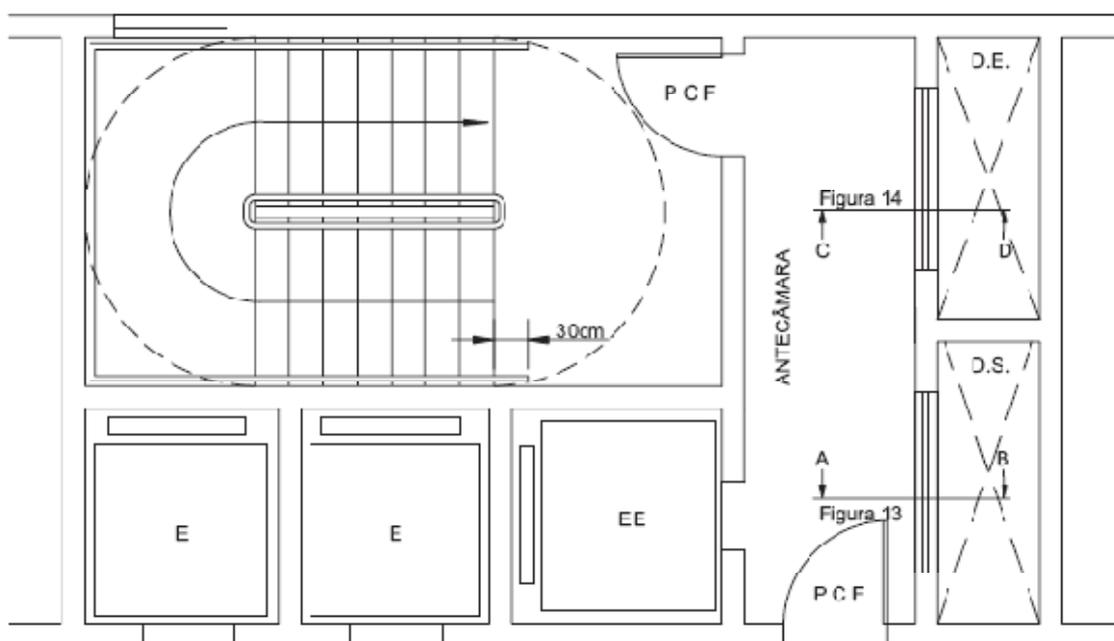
Escada enclausurada à prova de fumaça com elevador de emergência (a posição deste é somente exemplificativa) na antecâmara
